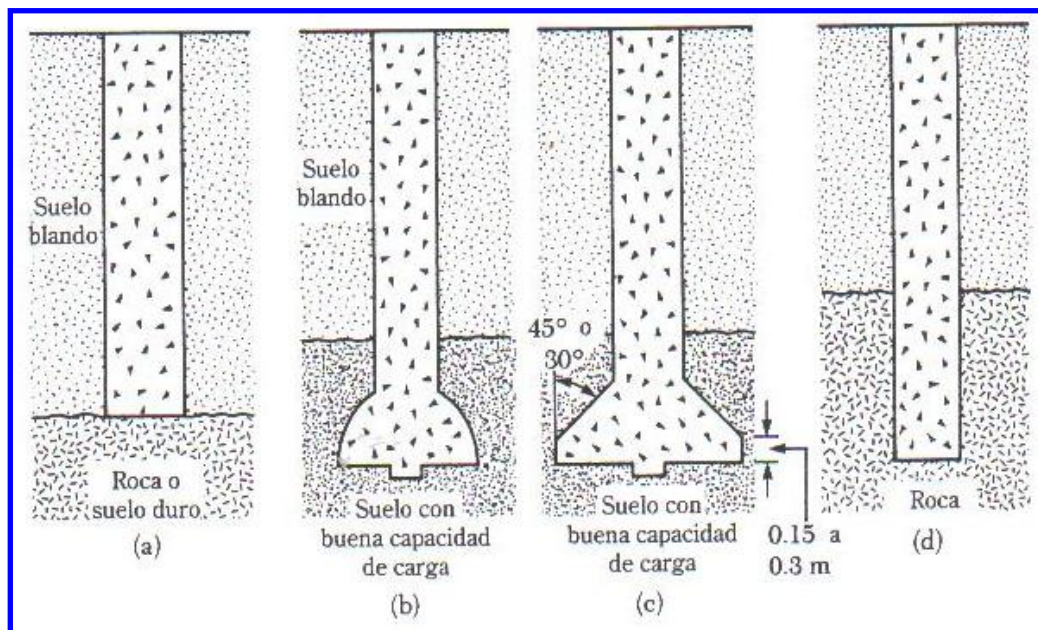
TIPOS DE PILAS (a) PILA RECTA, (b) y (c) PILA ACAMPANADA (d) PILA RECTA EMPOTRADA EN ROCA
